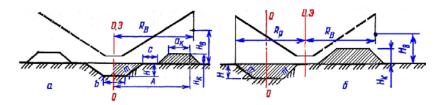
Способы разработки грунта: a – продольный; δ – поперечный
